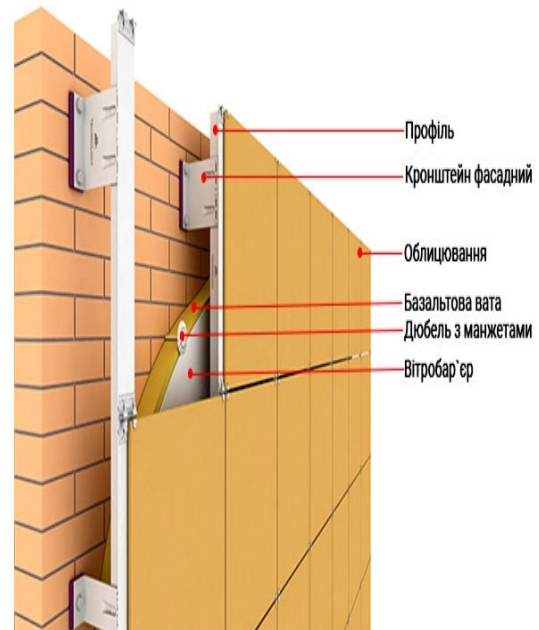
Розріз зовнішньої стіни з утепленням і оздобленням тонкою штукатуркою «вентильований фасад»
